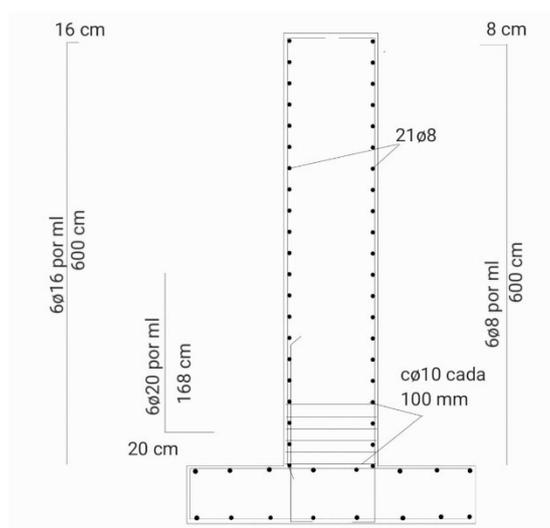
Disposición del armado para un muro de seis metros y canto constante (Fuente propia)
